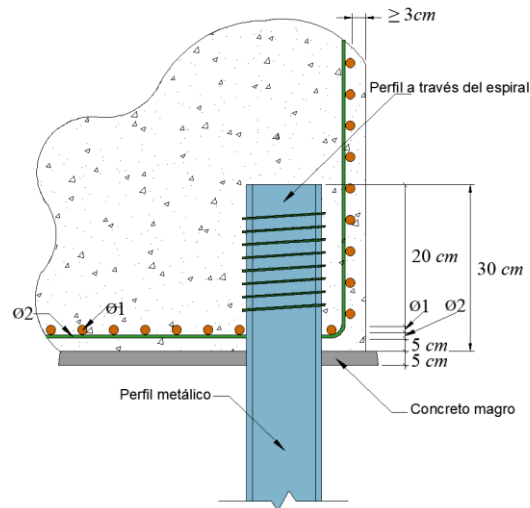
Unión de pilote de acero con elemento de concreto
